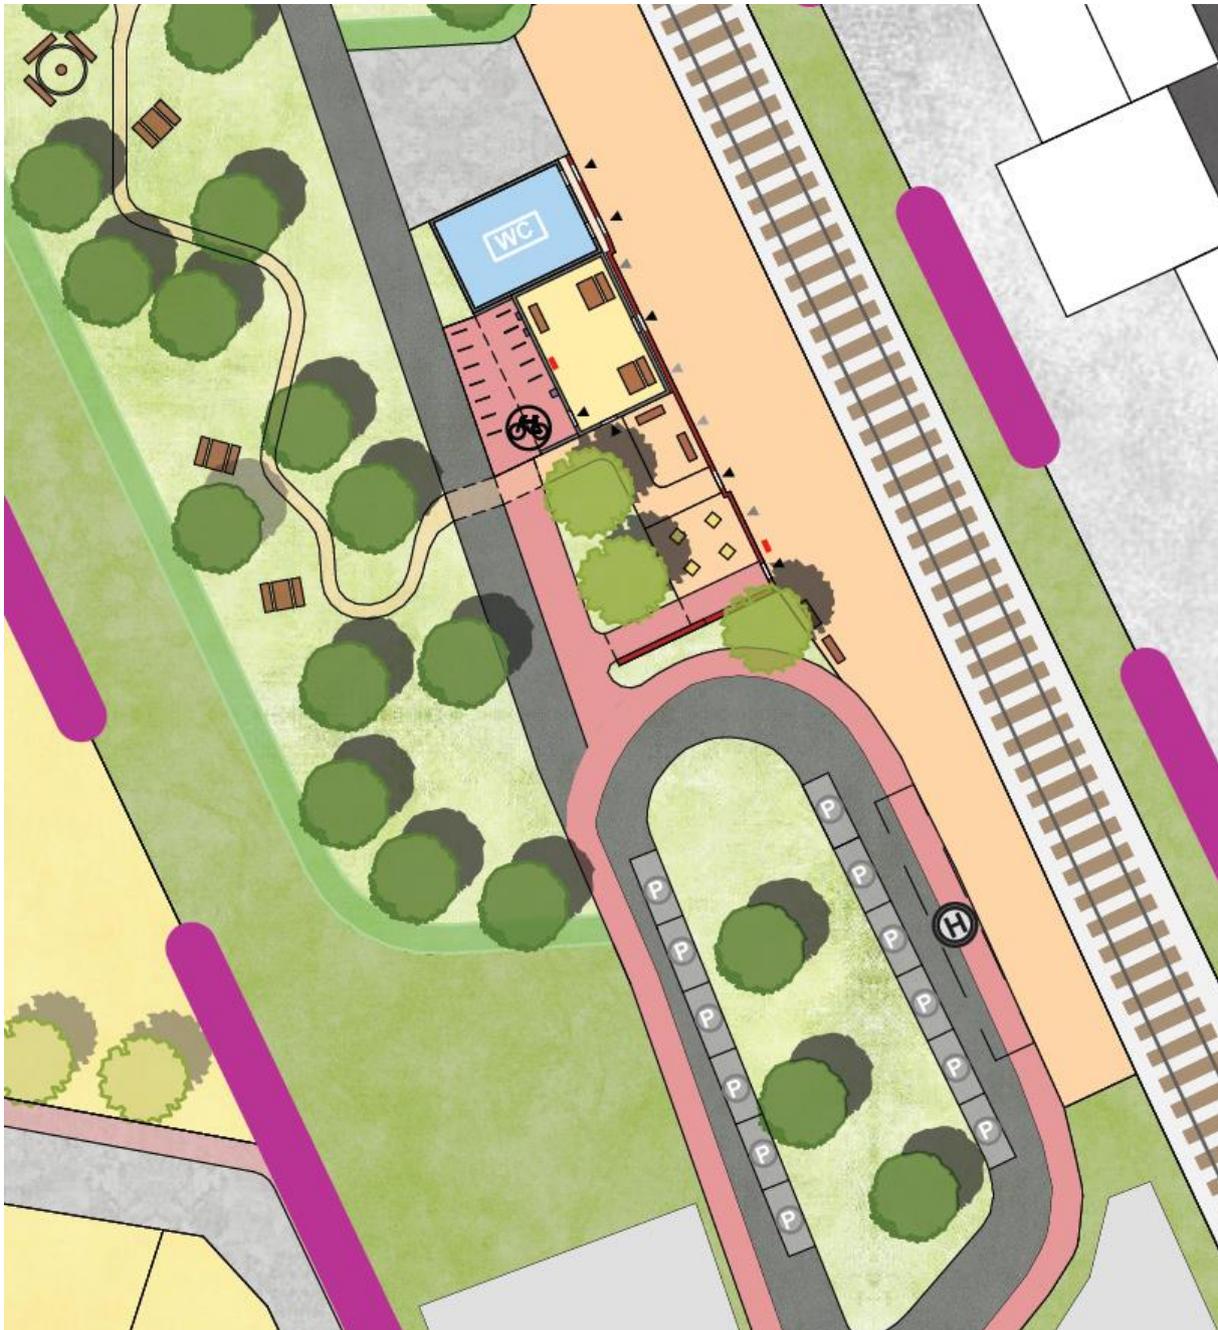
Auszug aus dem Lageplan TBP 1 Bahnhof Silberhausen
